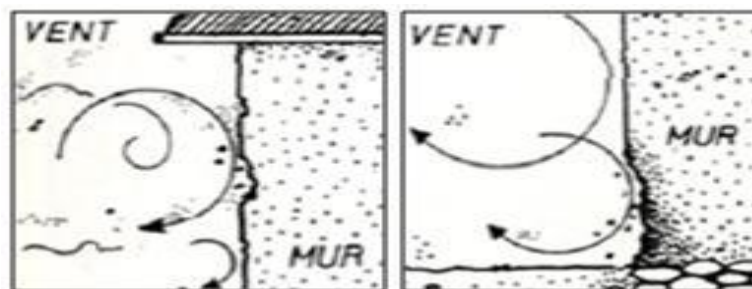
Action du vent en haut et bas d'un mur en adobe
